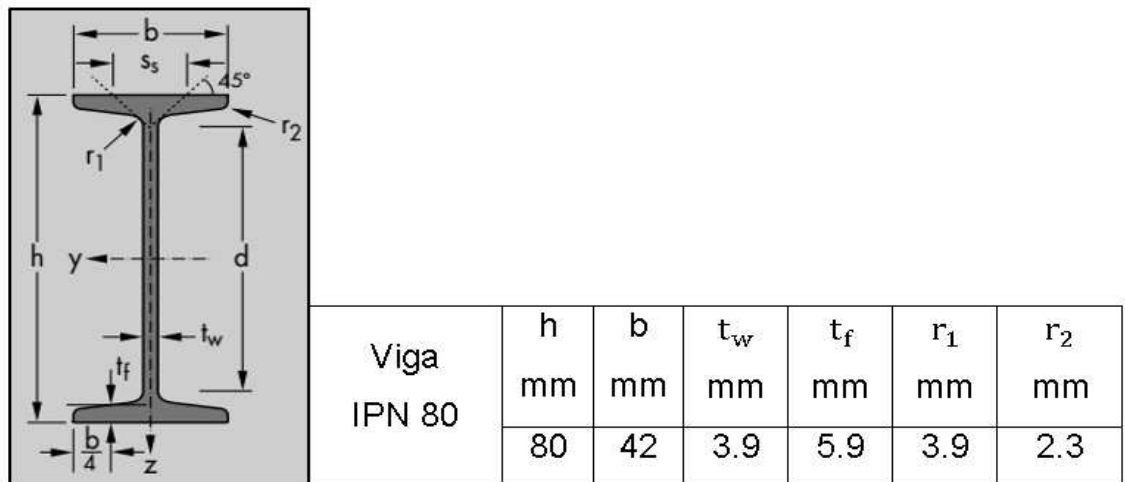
Dimensiones perfil viga IPN 80 [76].
